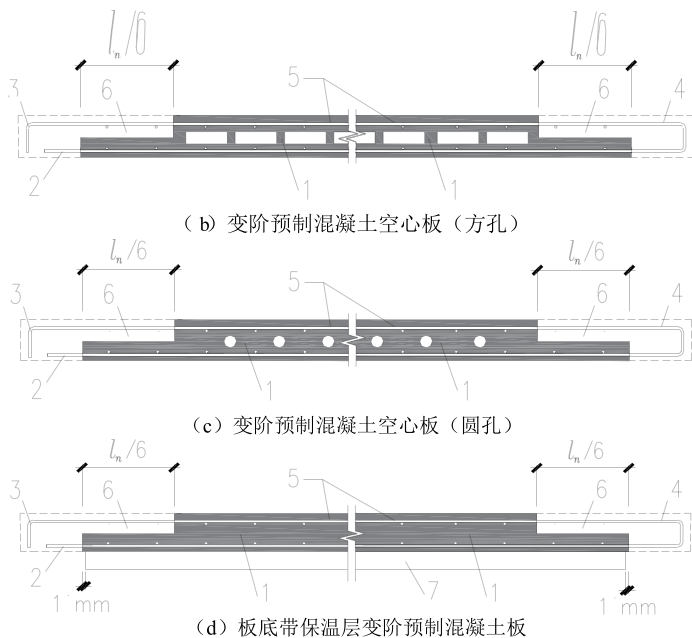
不同截面类型的变阶预制混凝土板剖面图（二）
